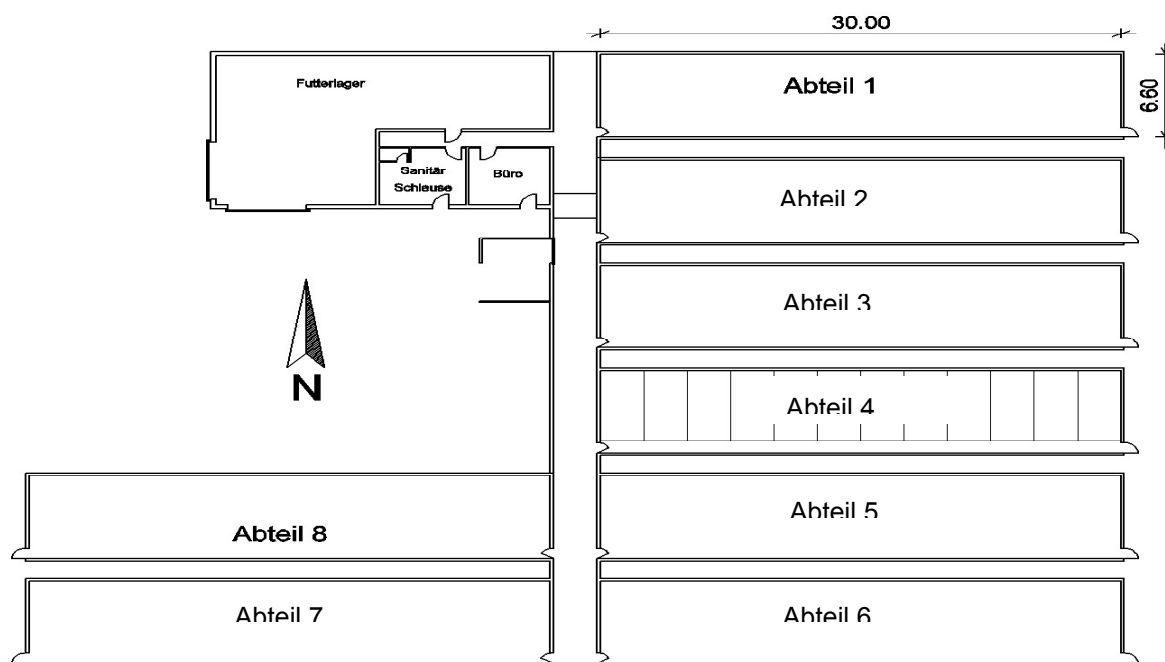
Grundriss Außenklima-Maststall Betrieb 1
